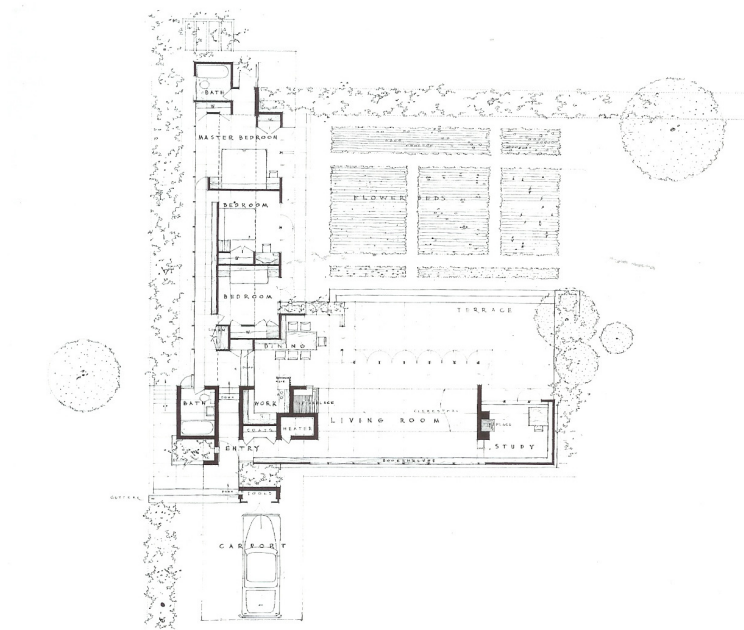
Planta da casa Stanley Rosenbaum - Frank Loyd Wright
